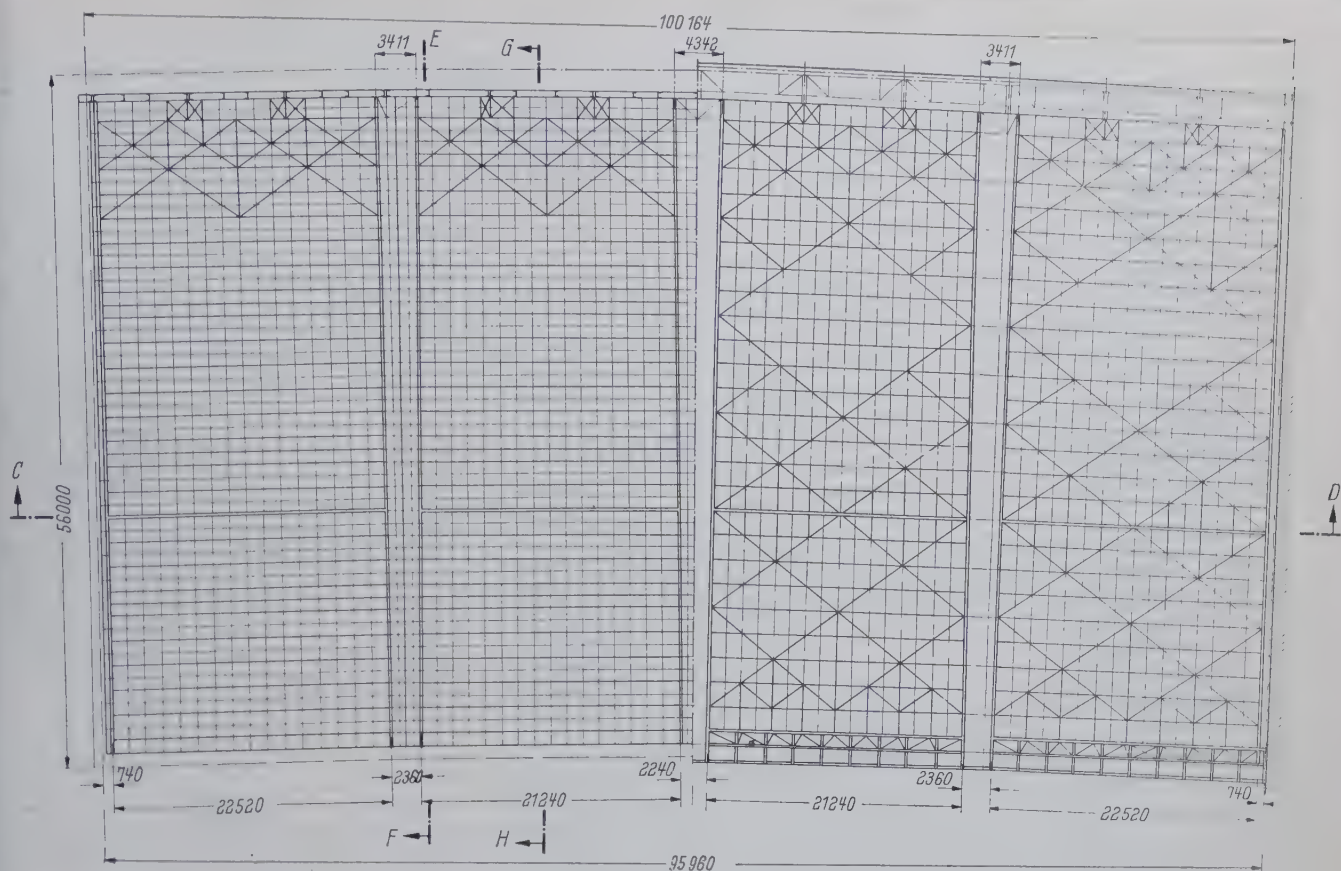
(Links) Draufsicht auf eine Hälfte der Dachkonstruktion der Halle. (Rechts) Schnitt durch eine Hälfte der Dachkonstruktion in halber Pfettenhöhe
